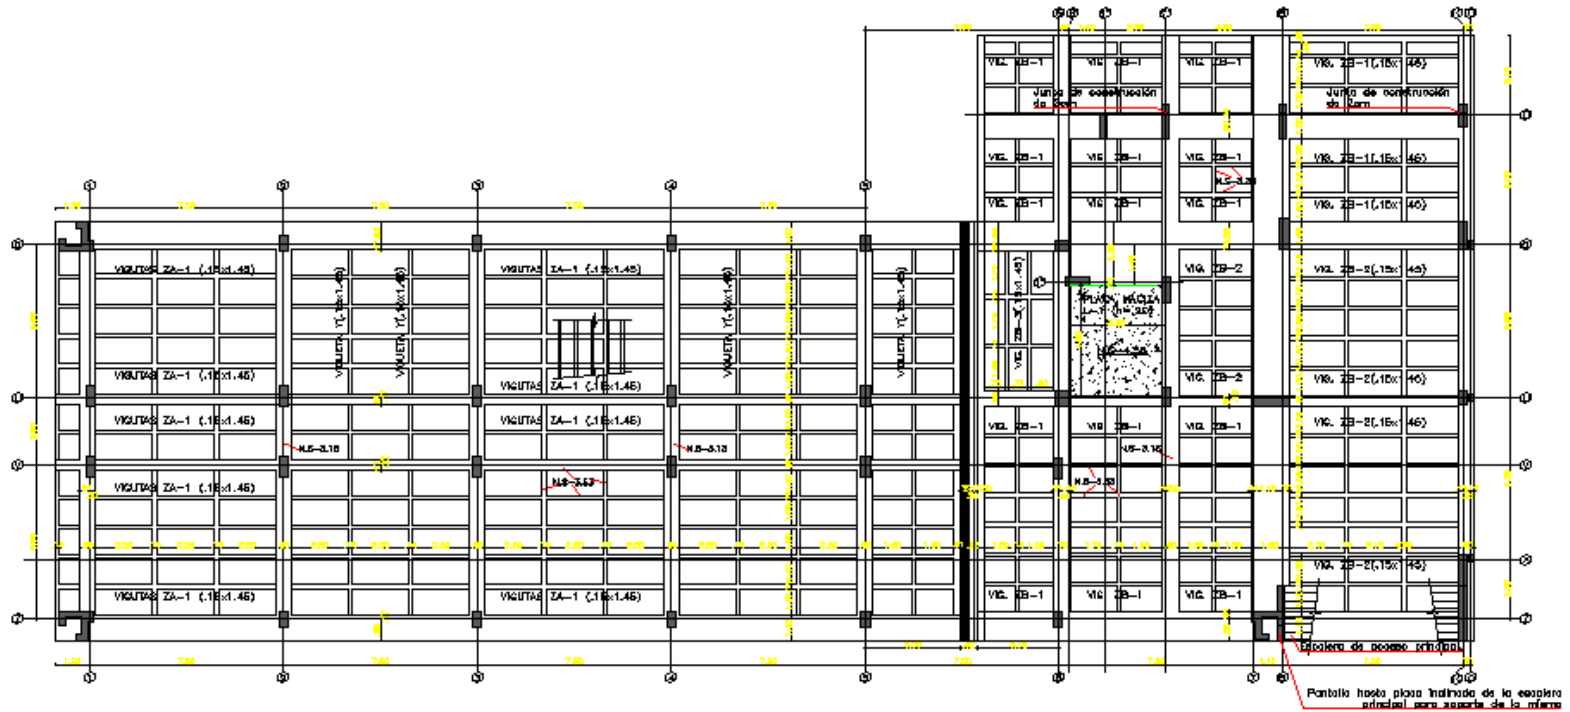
Cimentación de Estructuras 5 y 6 (Hotel y Gimnasio)
